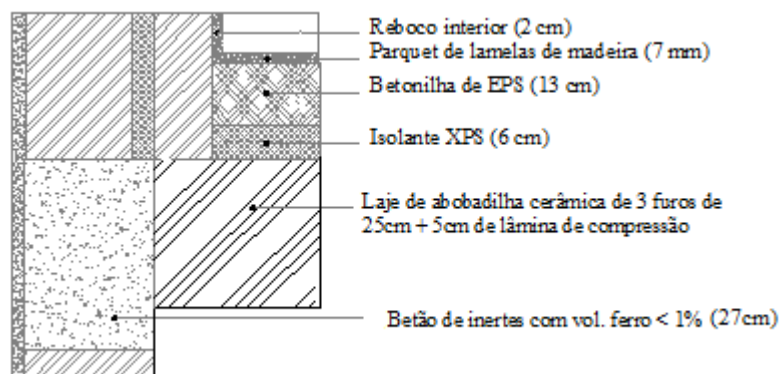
Pavimento térreo do tipo 1 – PavT1.
